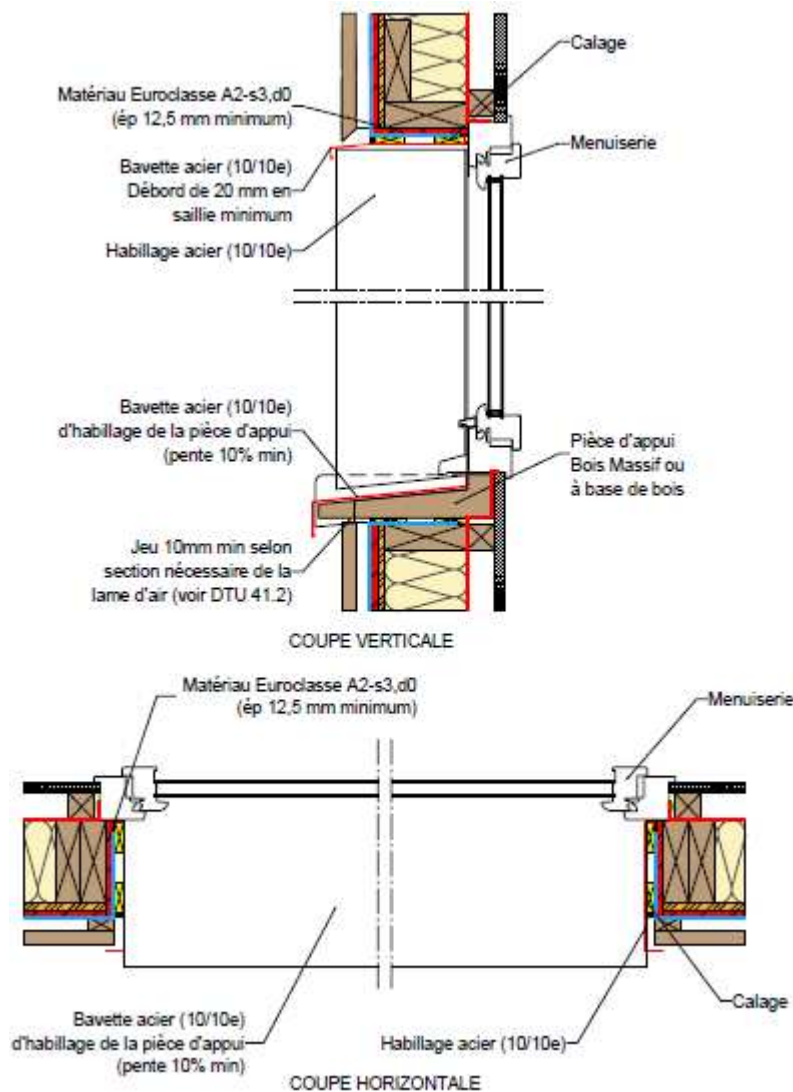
Coupe verticale et horizontale de l'habillage des baies
